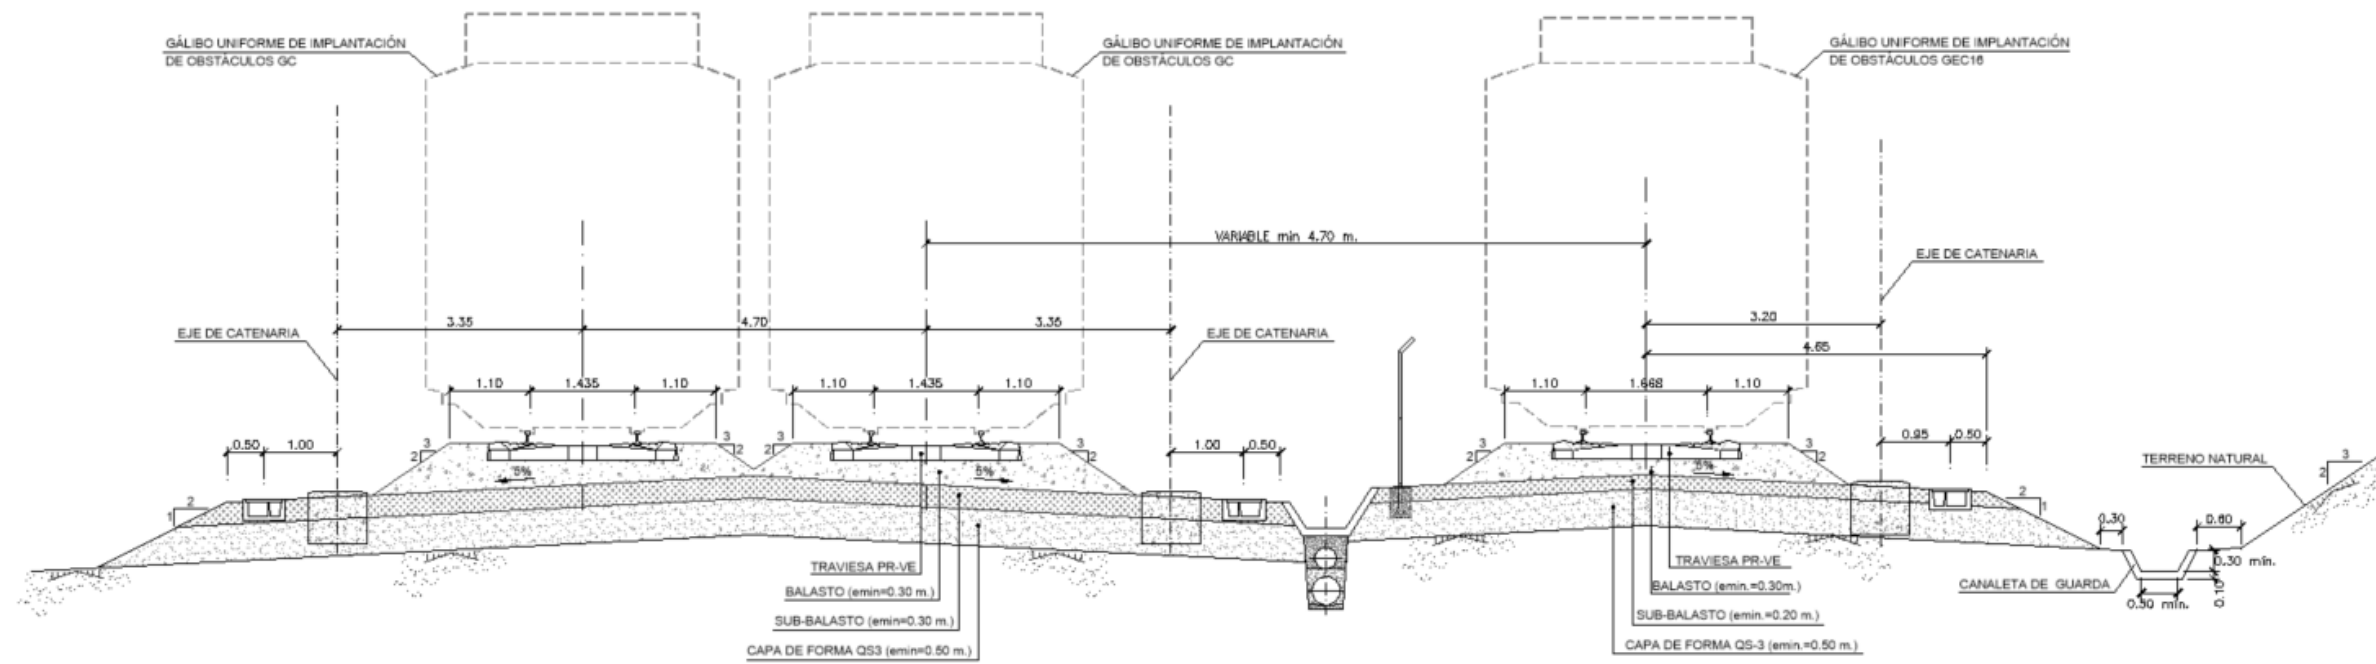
Sección tipo plataformas paralelas (ancho 2 UIC + 1 Ibérico)
